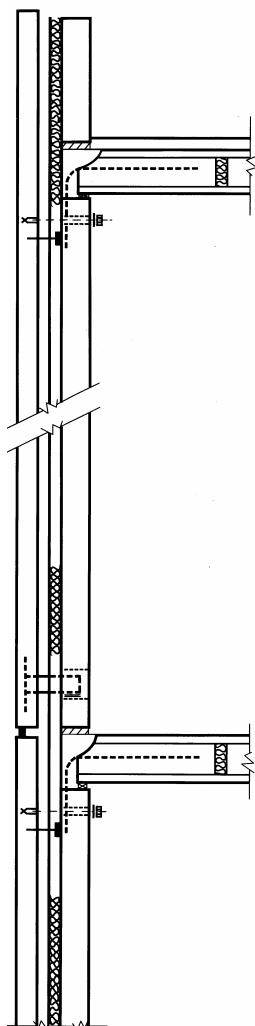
Passos de montagem para sistemas de “pele dupla” para fachadas
